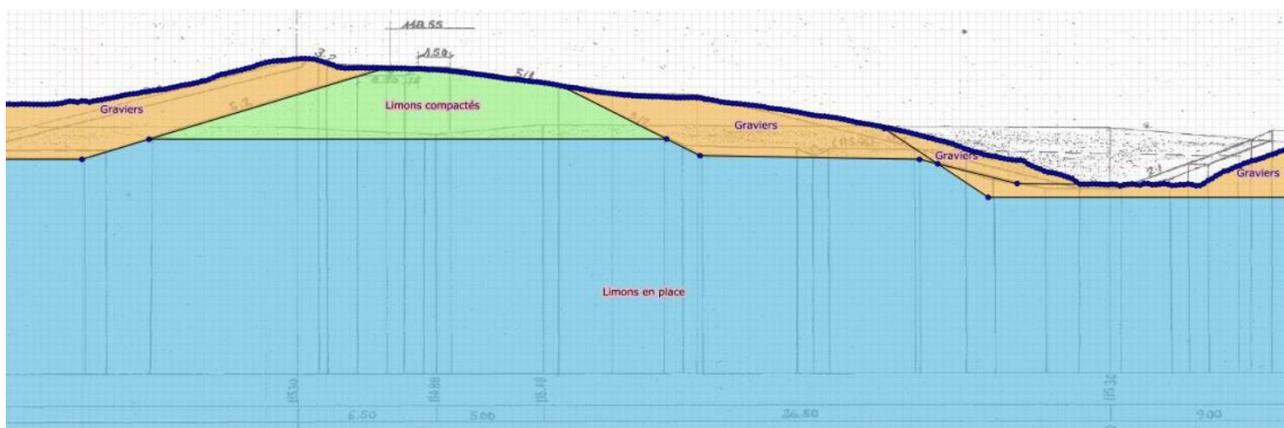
Coupe de calcul – Rive gauche aval (avec Profil en travers n°39, échelle horizontale déformée)
